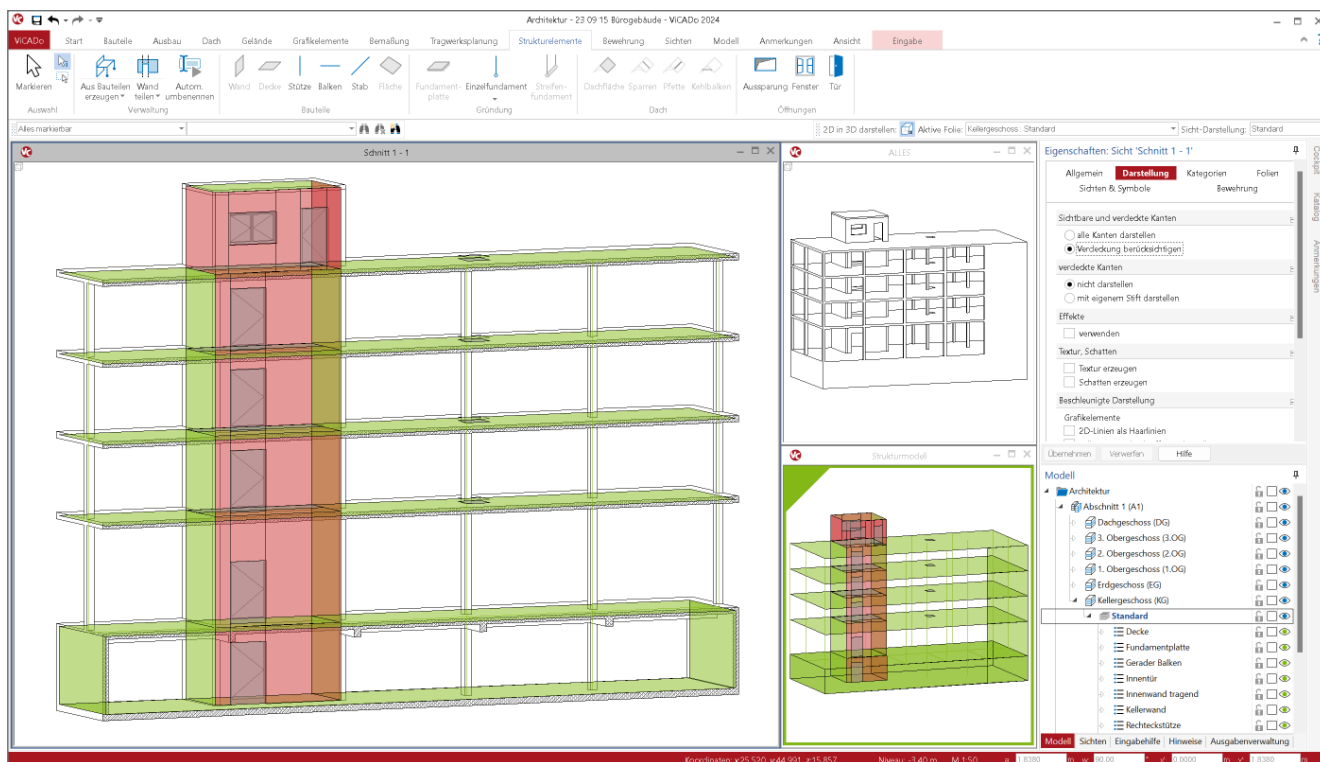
Modelle in der Tragwerksplanung (Architekturmodell rechts oben, Strukturmodell rechts unten)
